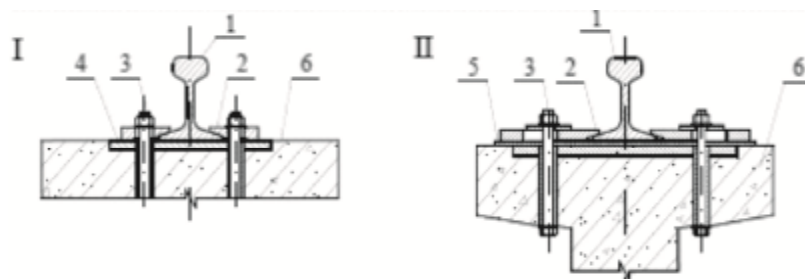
Крепление рельсовых путей к железобетонной балке:
